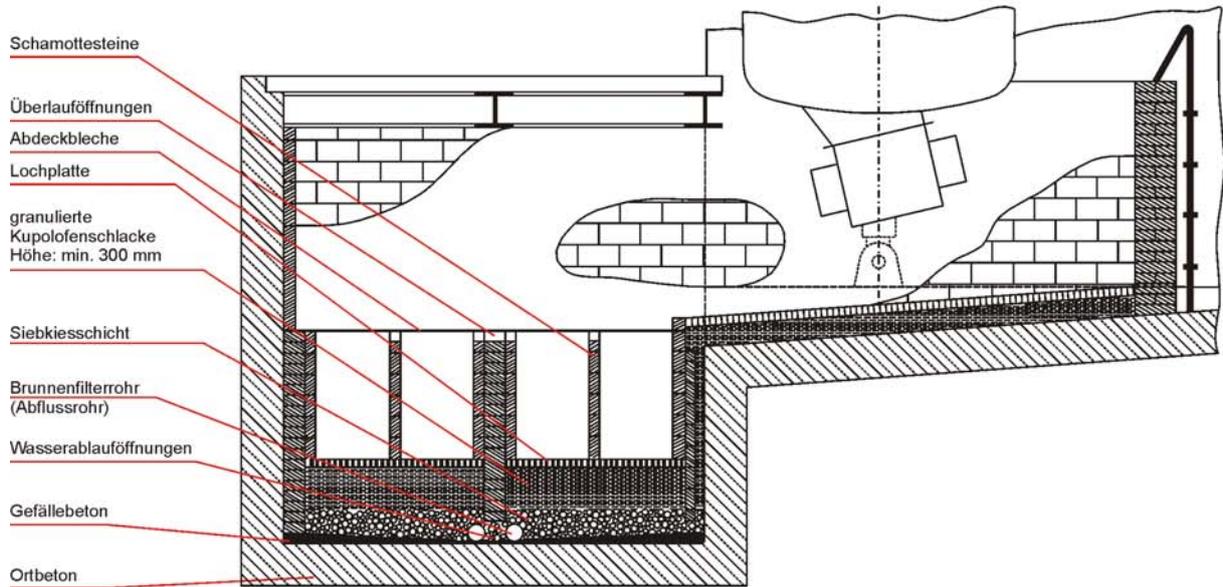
Notauffanggrube mit Drainage ausschließlich im Bodenbereich
